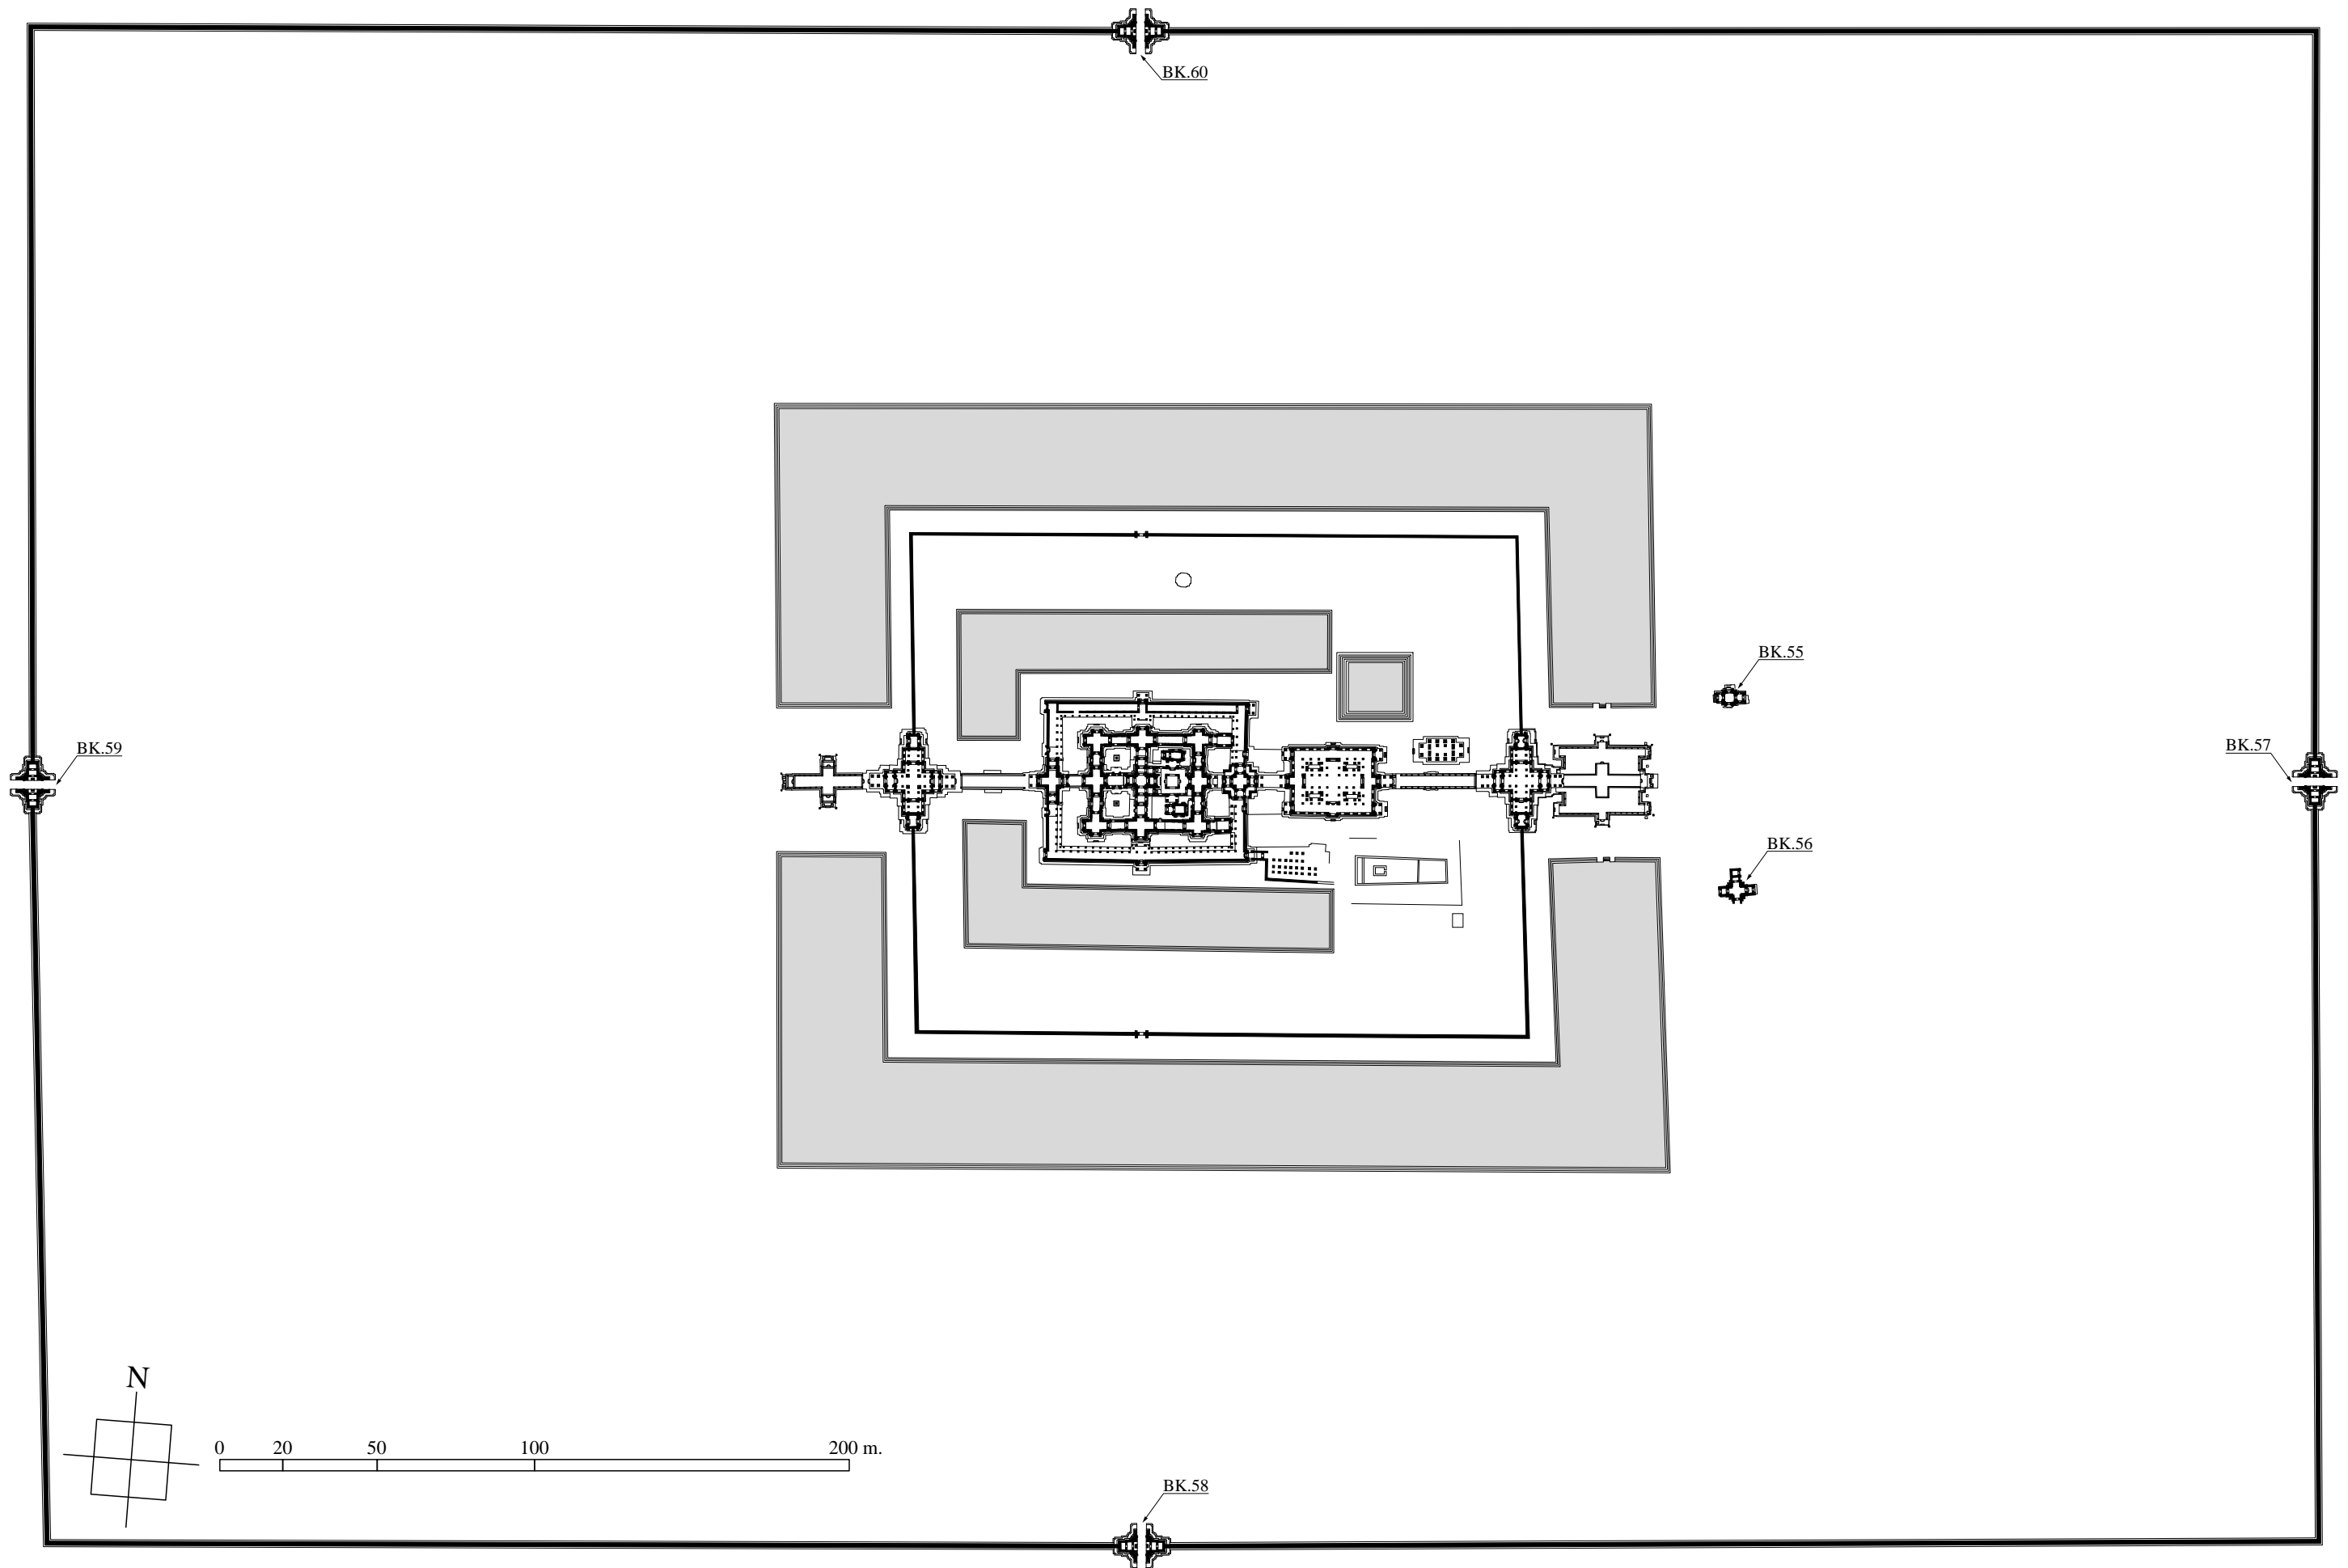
Plan du domaine de Banteay Kdei
